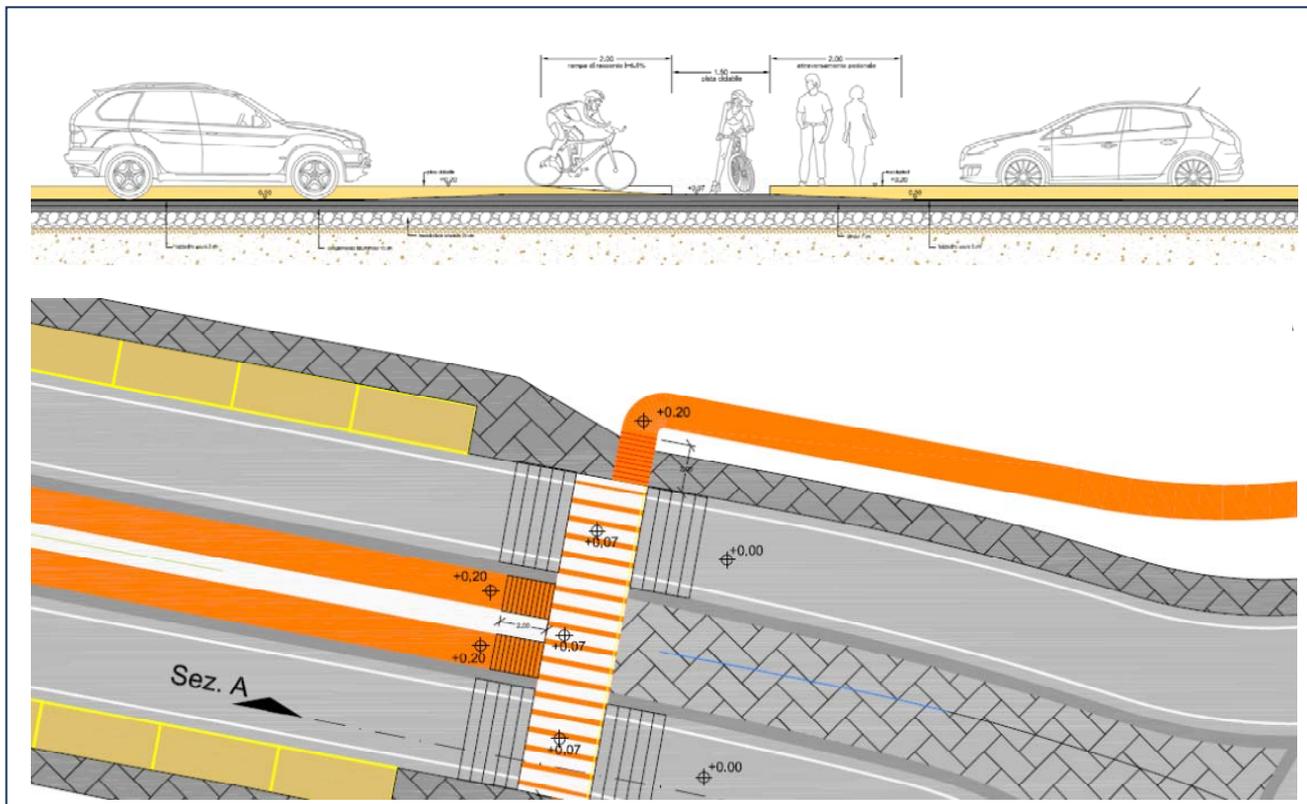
b Stralcio planimetrico e sezione attraversamento ciclo pedonale
